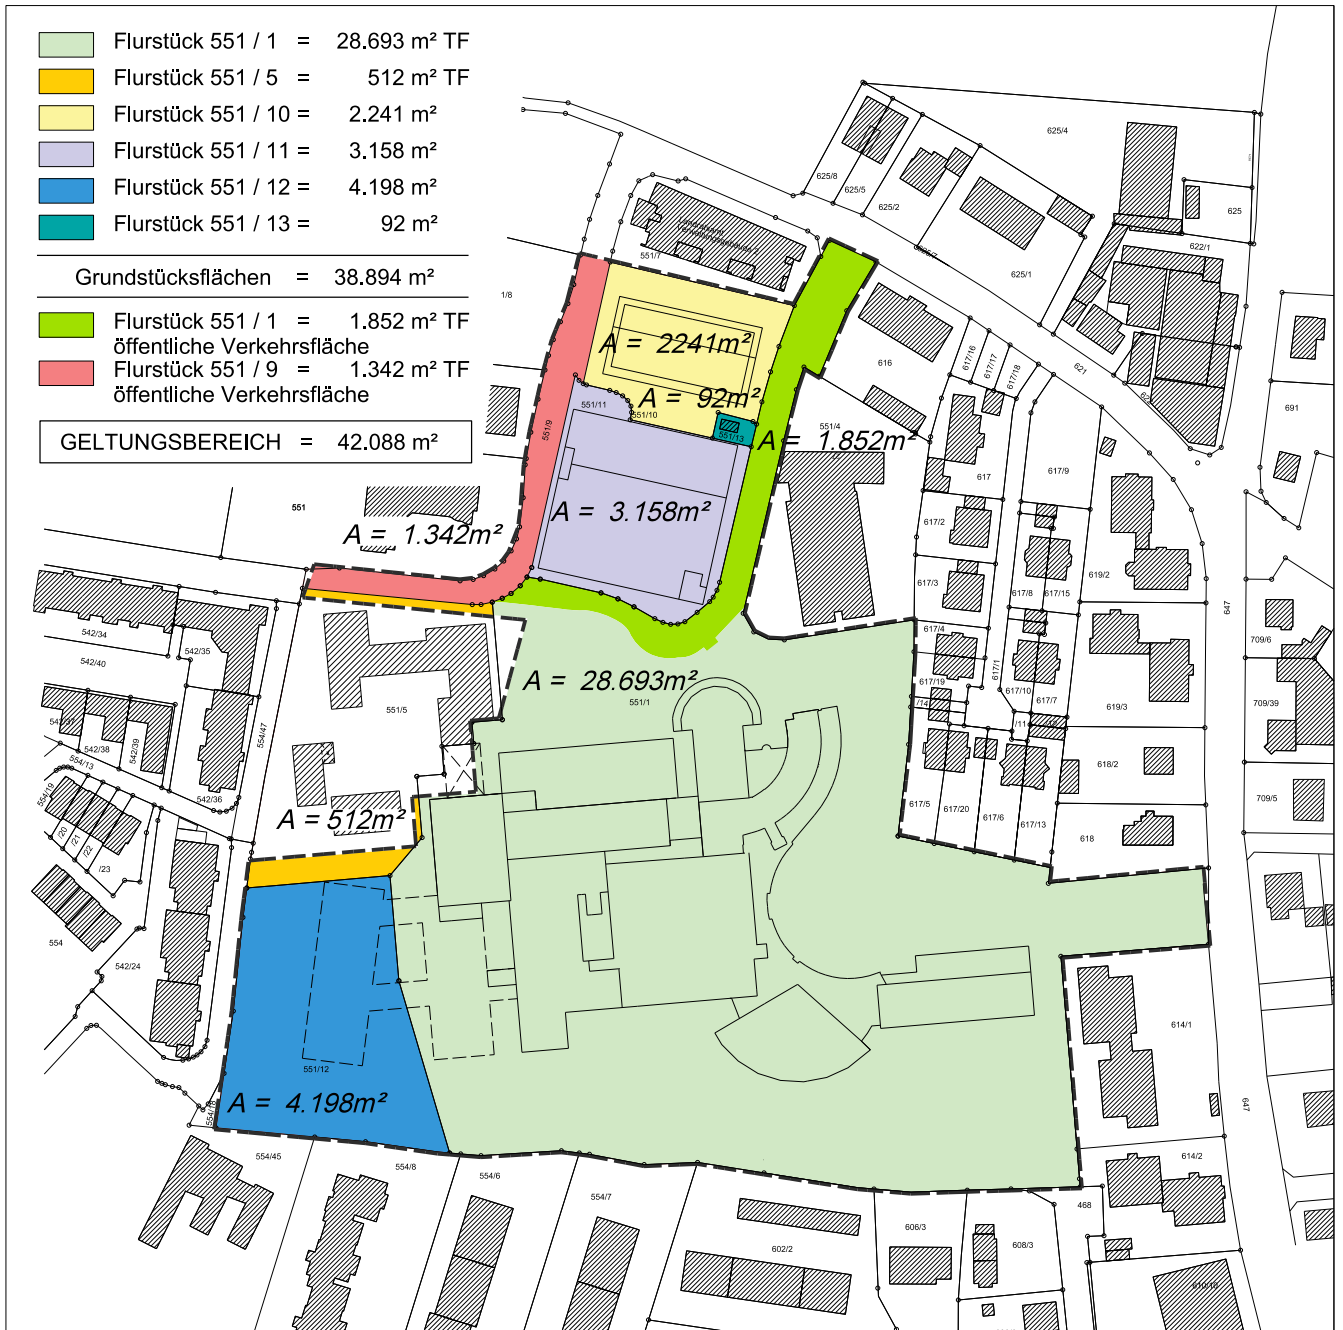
Lageplan Übersicht Flurstücke - Nachweis GRZ / GFZ nach § 19 und 20 BauNVO, ohne Maßstab
